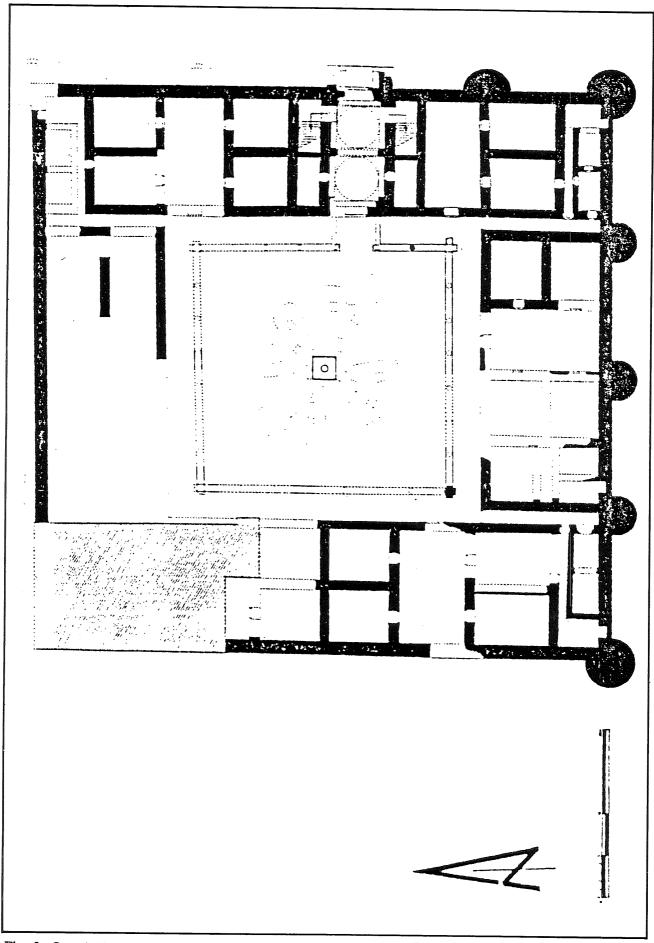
Qastal 83: le palais: état Umayyade. Plan du-rez-de Chaussée. En pointillé, les parties restituées. Relevé: F. Morin et l'équipe Dessin: S. Metz.
